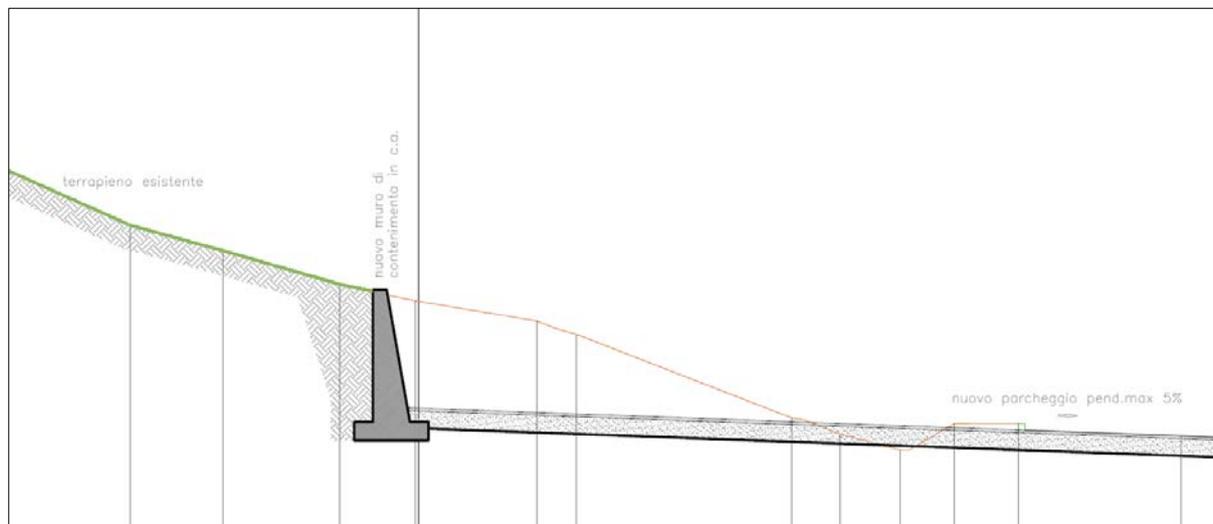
Sezione tipo di progetto con indicazione del profilo del suolo del versante interessato.
